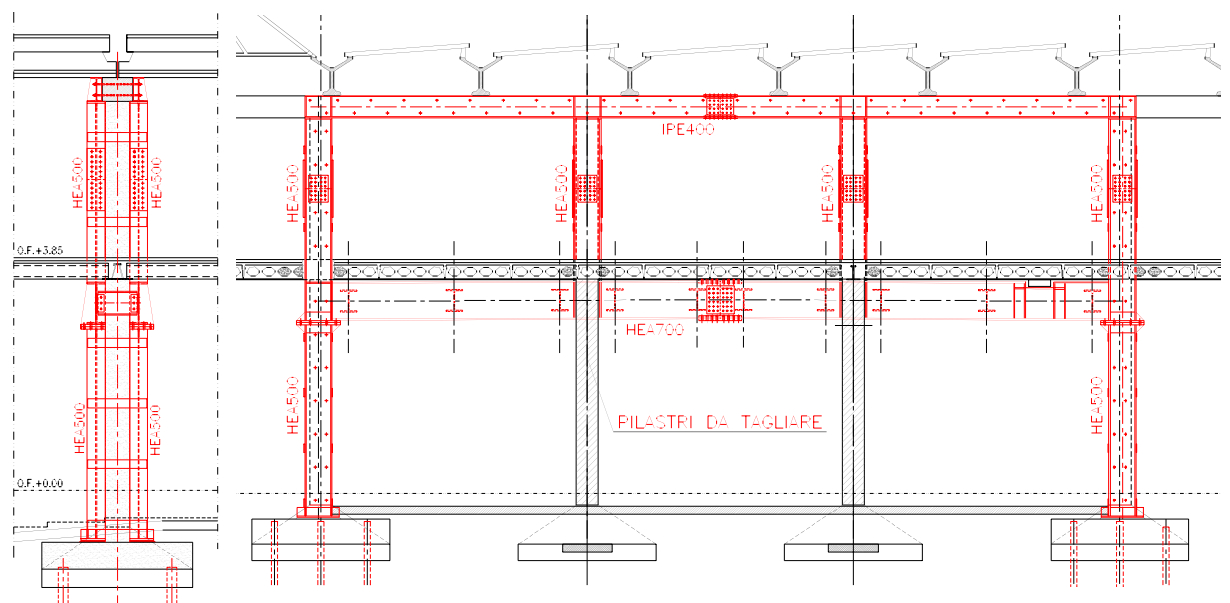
Trave Vierendeel di rinforzo; a sinistra: sezione trasversale della struttura
